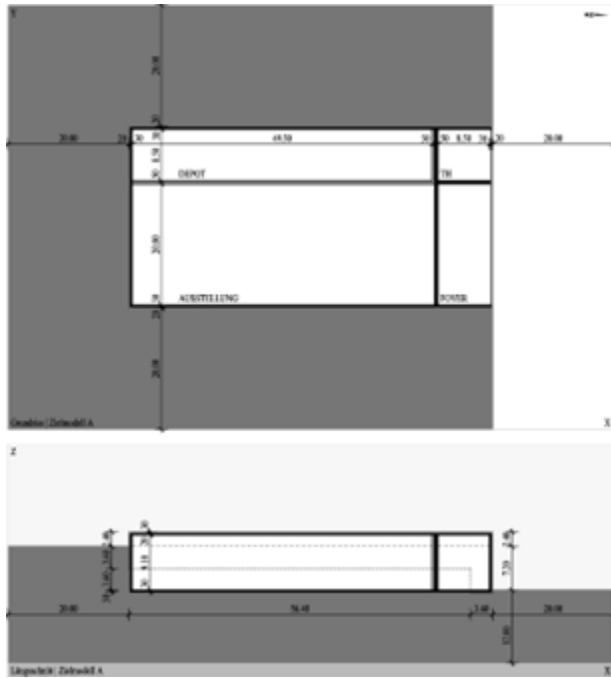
Zielmodell, Grundriss- und Schnittzeichnung - Depot, Treppenhaus, Foyer, Ausstellung
